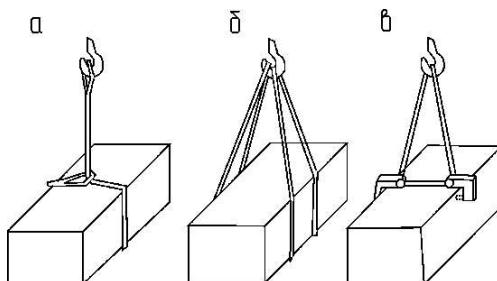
Схема строповки блоків канатними вантажозахватними пристроями [2]
